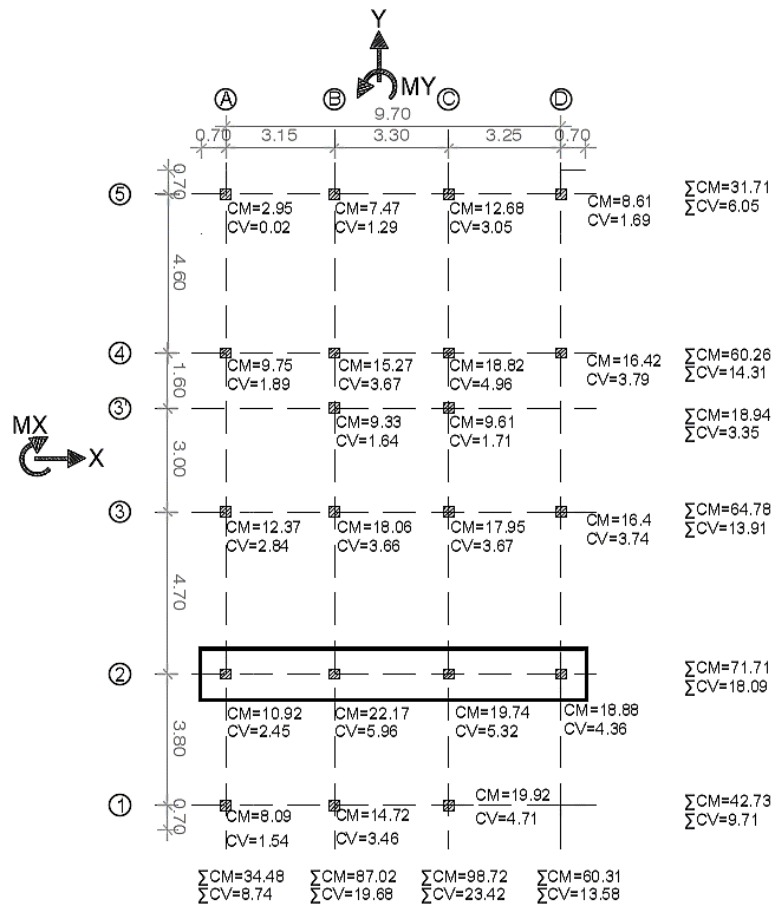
Planta de la edificación en la zapata corrida más crítica, y cargas verticales
